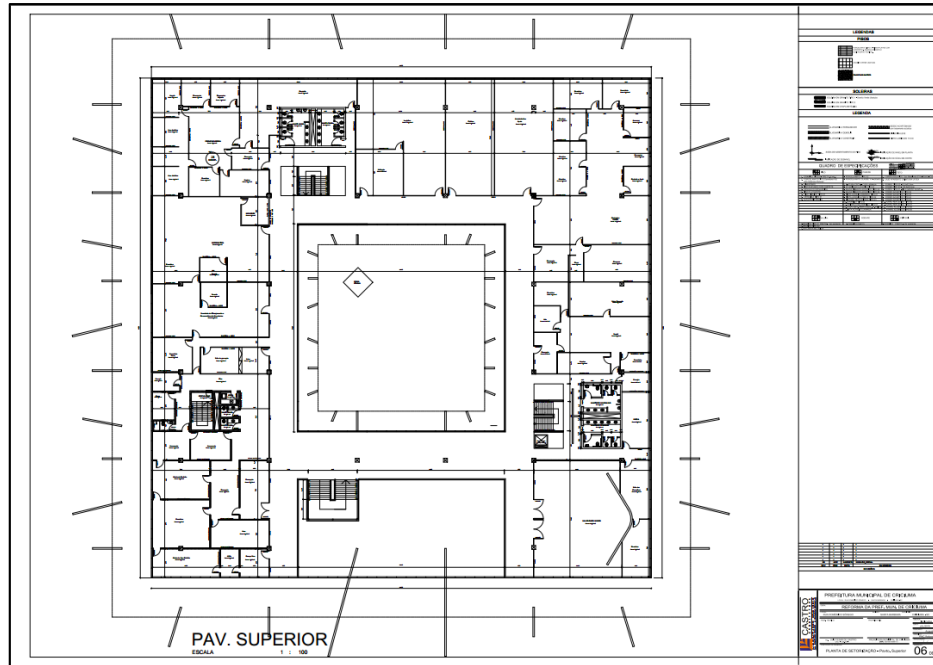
Planta baixa pavimento superior. (Fonte: PMC)
